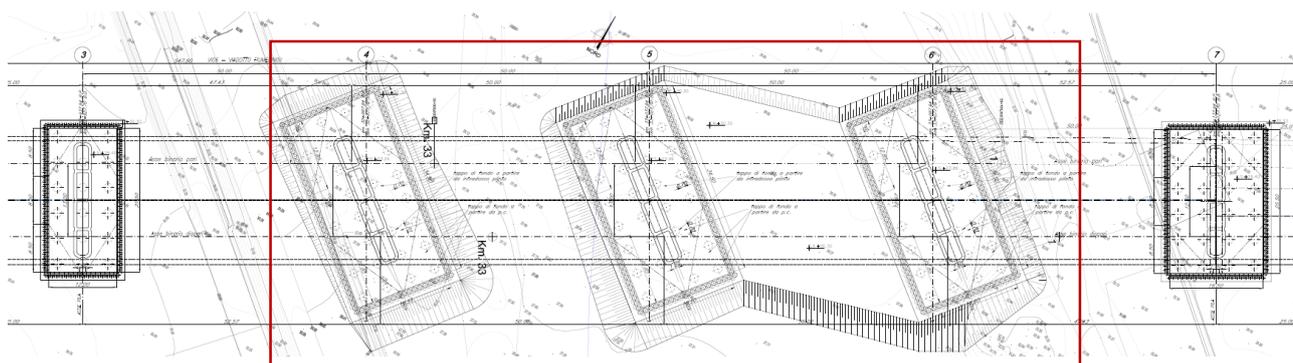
Viadotto VI05 – PD – Pianta scavi fondazioni
